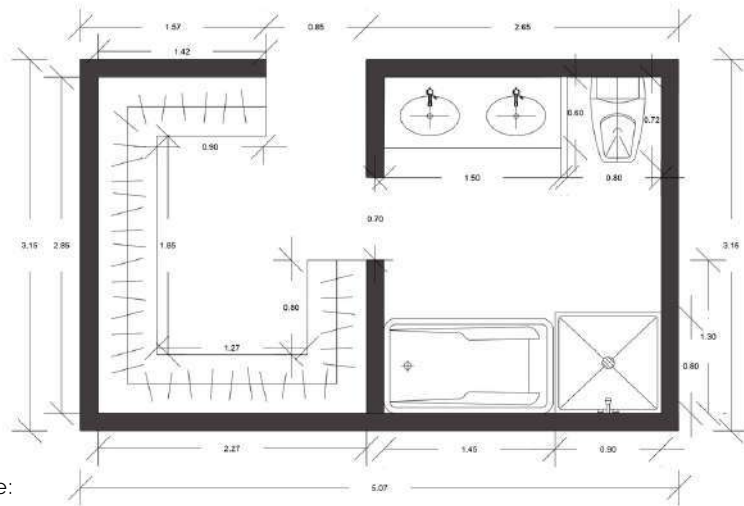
Planta de baño acotada. Fuente: Autoría propia.
